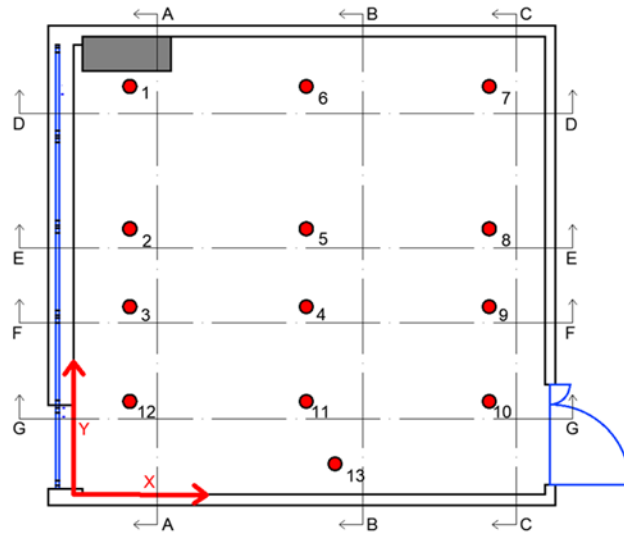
Planimetria con individuazione delle sezioni di riferimento: D-D; E-E; F-F
